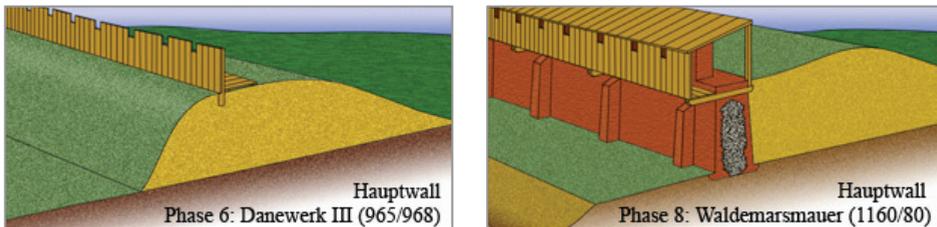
Schematische Darstellung des Hauptwalls um 965 (links) und der Waldemarsmauer um 1170 (rechts)
